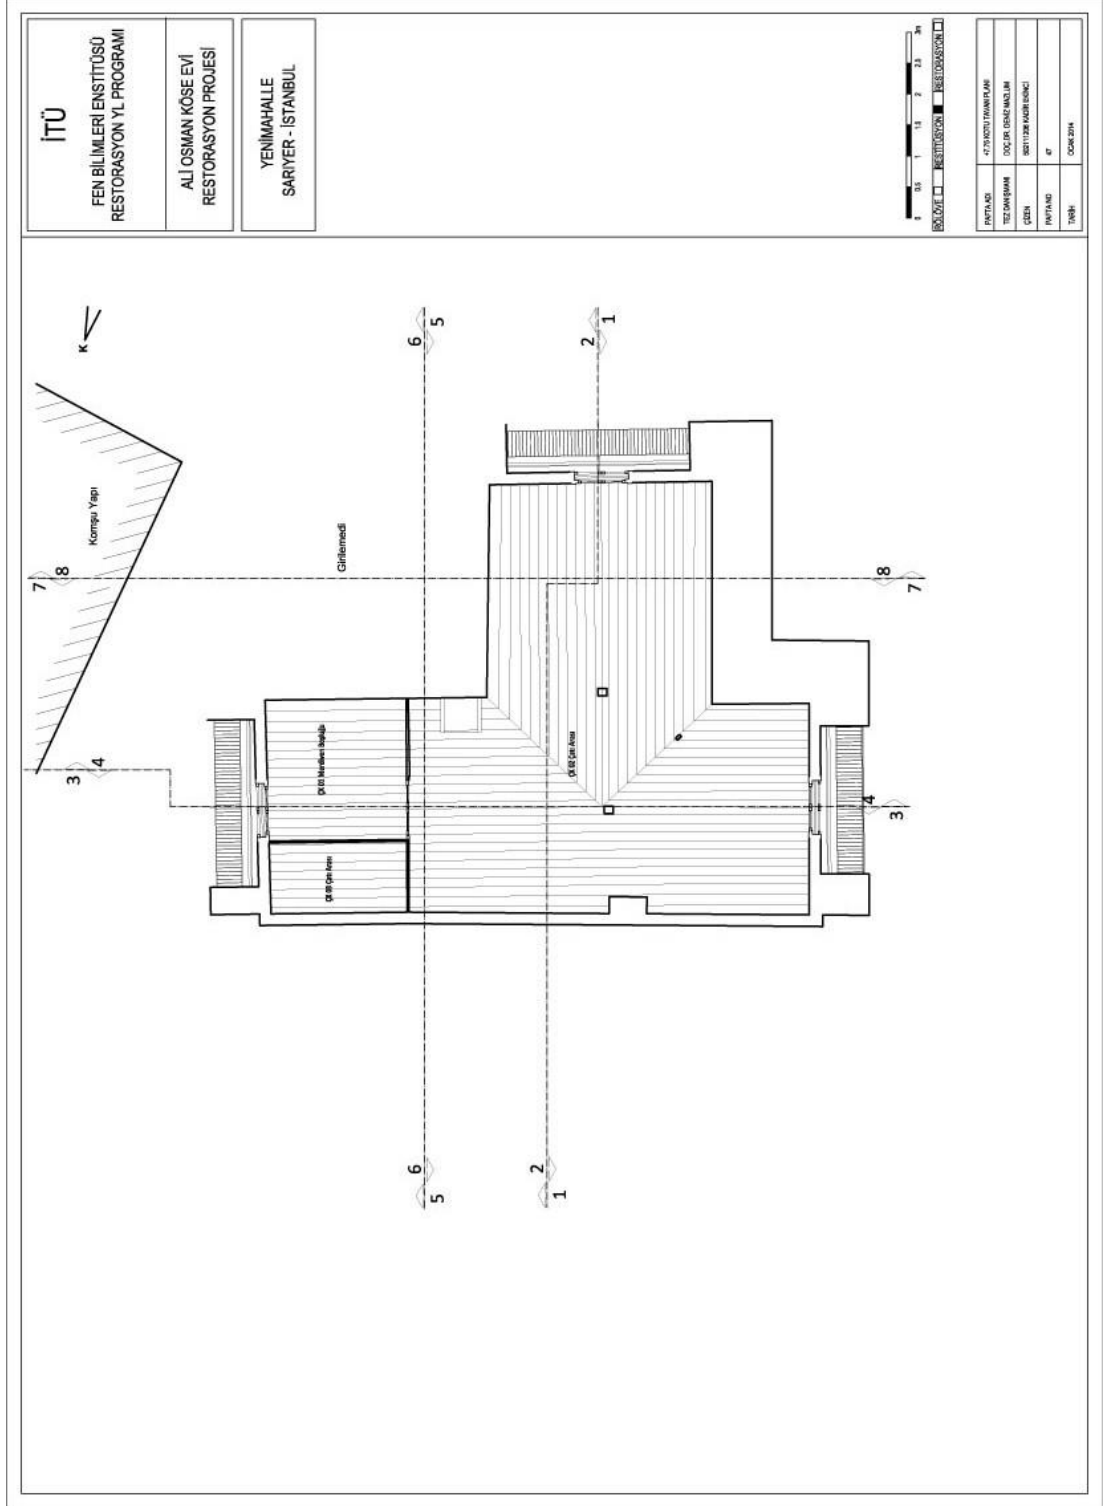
Restitüsyon – -0.45 kotu tavan planı.
